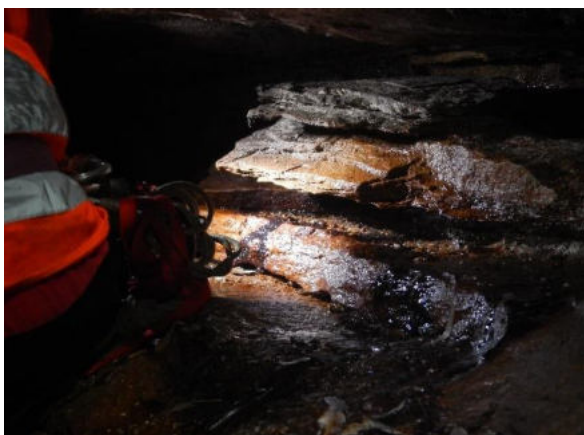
Detalhe do escorrimento com concentração de óxido de ferro..
